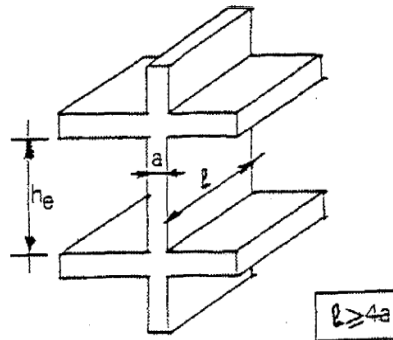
Coupe de voile en élévation (RPA99/2003).
